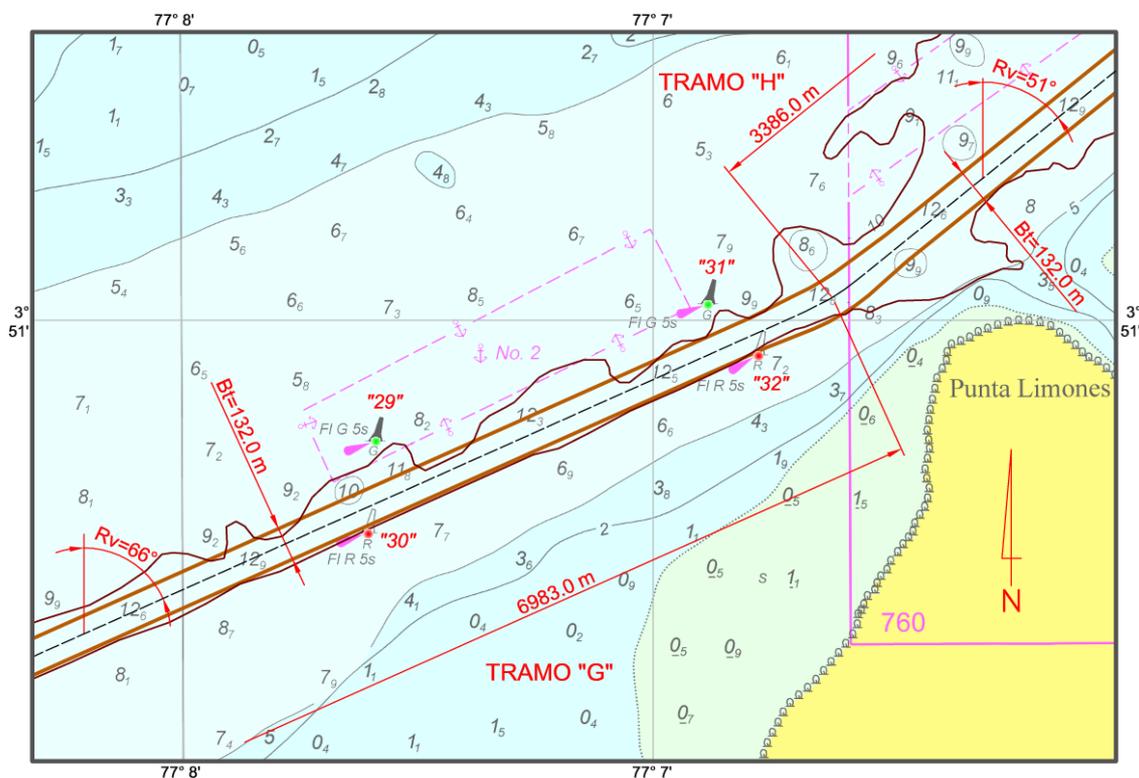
Dimensionamiento en planta de un tramo del canal de navegación
